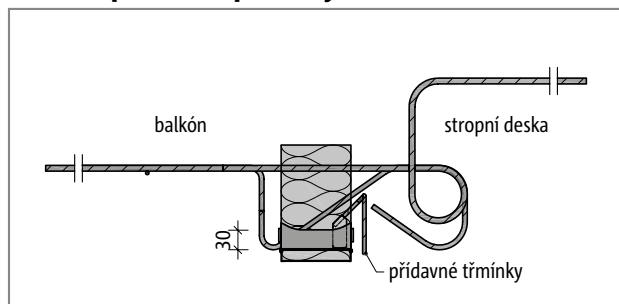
Schöck Isokorb® typ KXT25-HV, KXT30-HV: Řez prvkem
